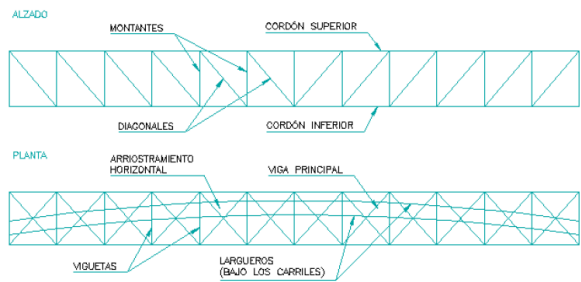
Esquemas del alzado y planta del viaducto sobre el Mascarat
